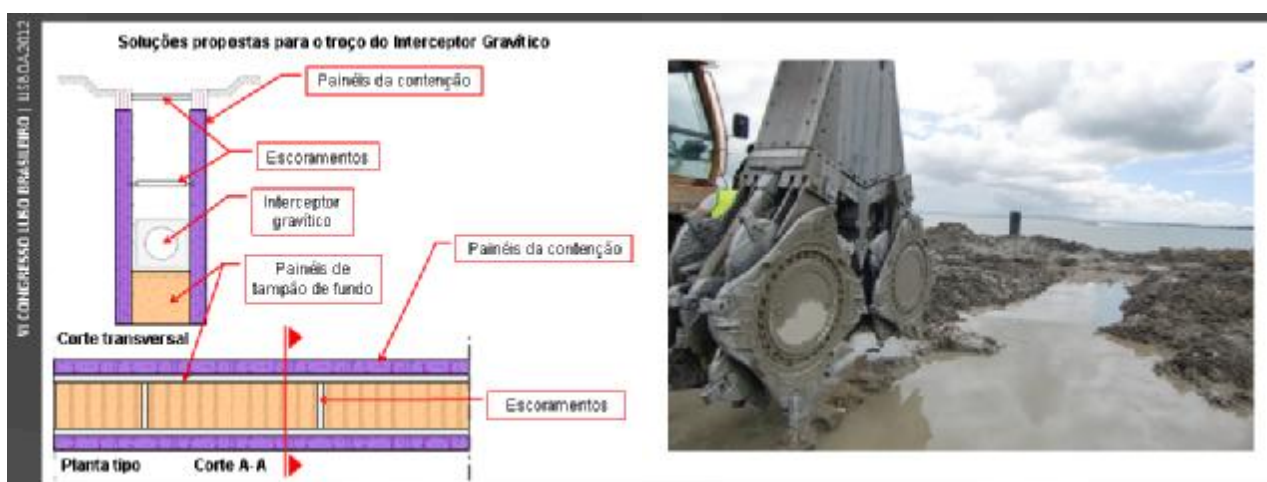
Secção transversal e planta das soluções adoptadas para a vala do Interceptor. Rodas de corte “cutters” do equipamento de CSM.
